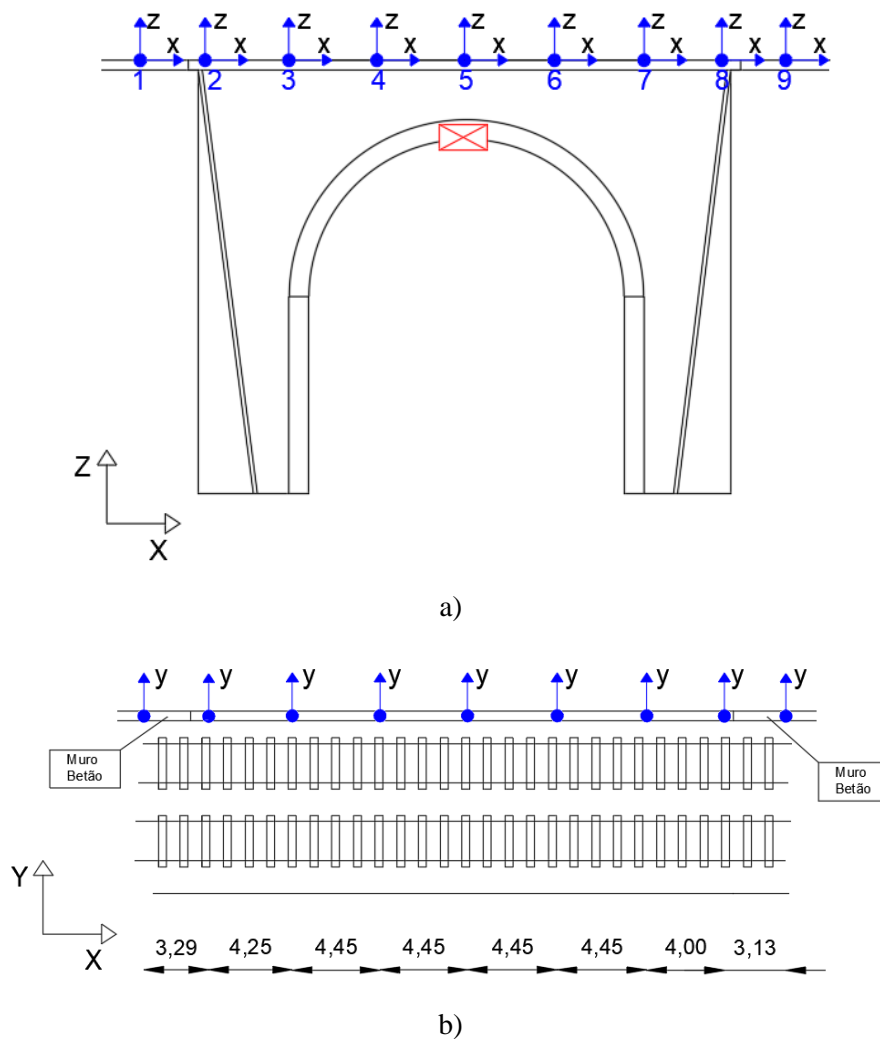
Esquema de ensaio: a) vista em alçado e b) vista em planta.
